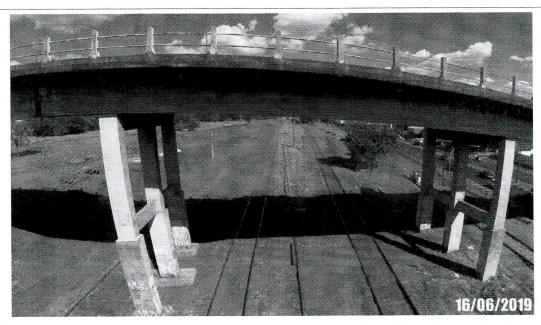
Vista da face lateral da viga com infiltração, eflorescência e desplacamento de concreto.
